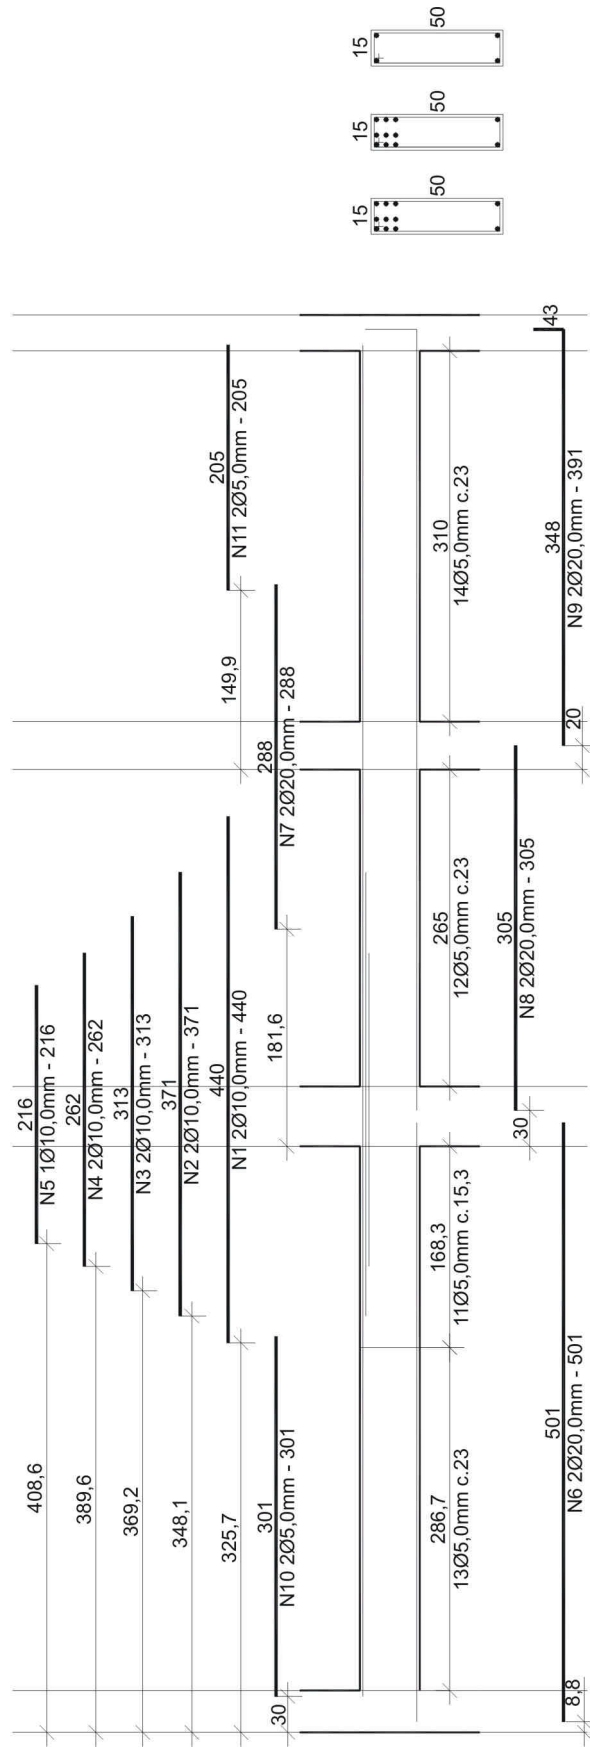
Detalhamento Viga 04.5, realizado pelo VigaCalc.
